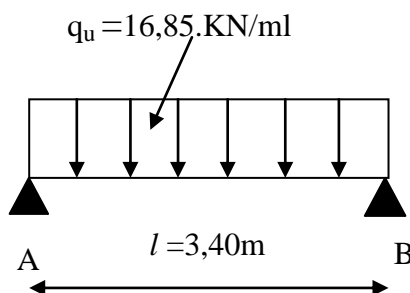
Figure II.a : schéma statique de la poutre de chaînage à l'ELU.
